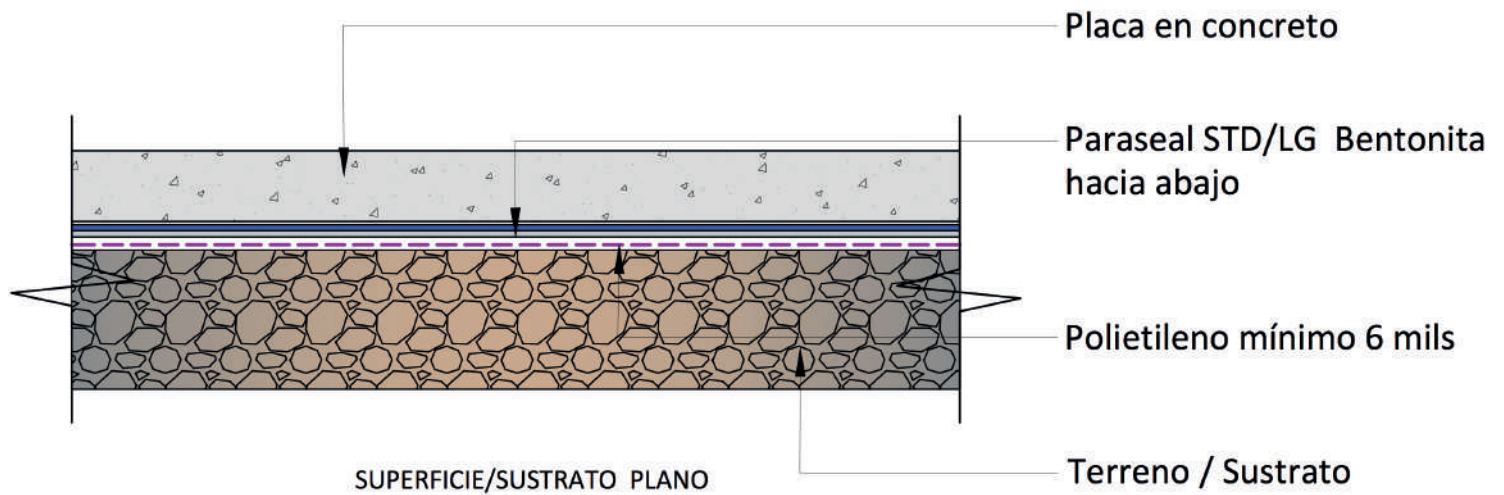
Detalle PARASEAL STD/LG sobre subrasante o terreno natural.
